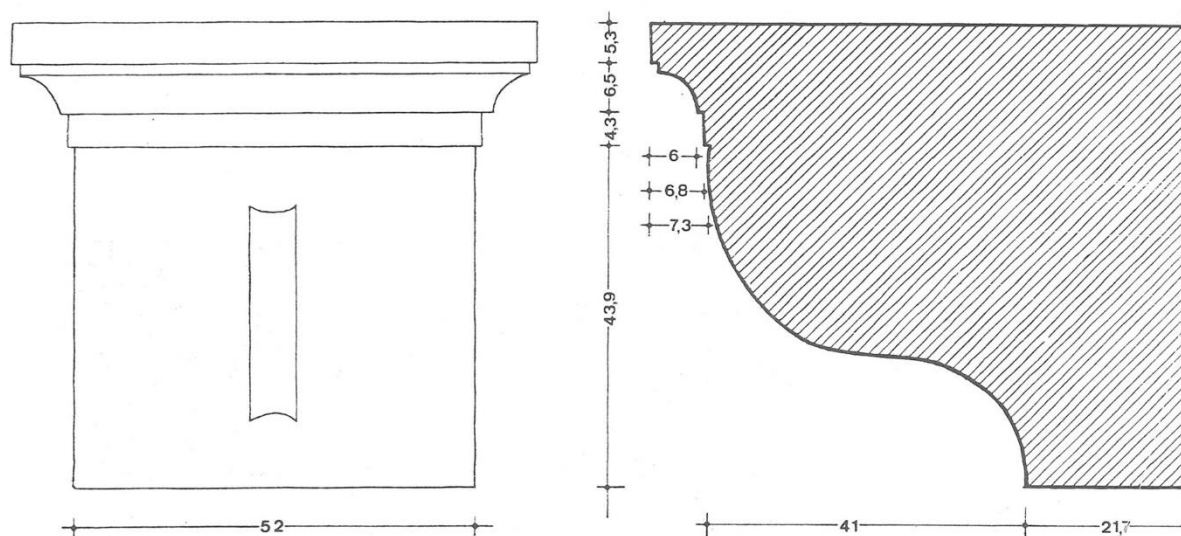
Plan et coupe d'une console de la summa cauea du stade de Cibyra
